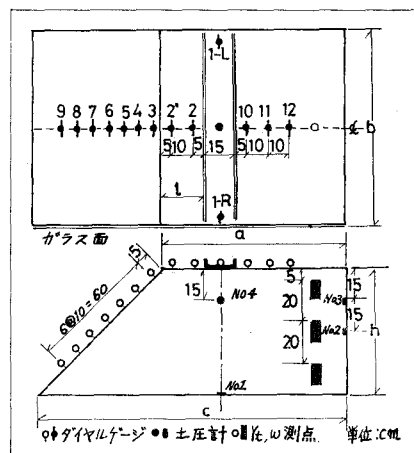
供試体形状寸法、土圧計、ダイヤルゲージ等の配置図 (SS-3)
